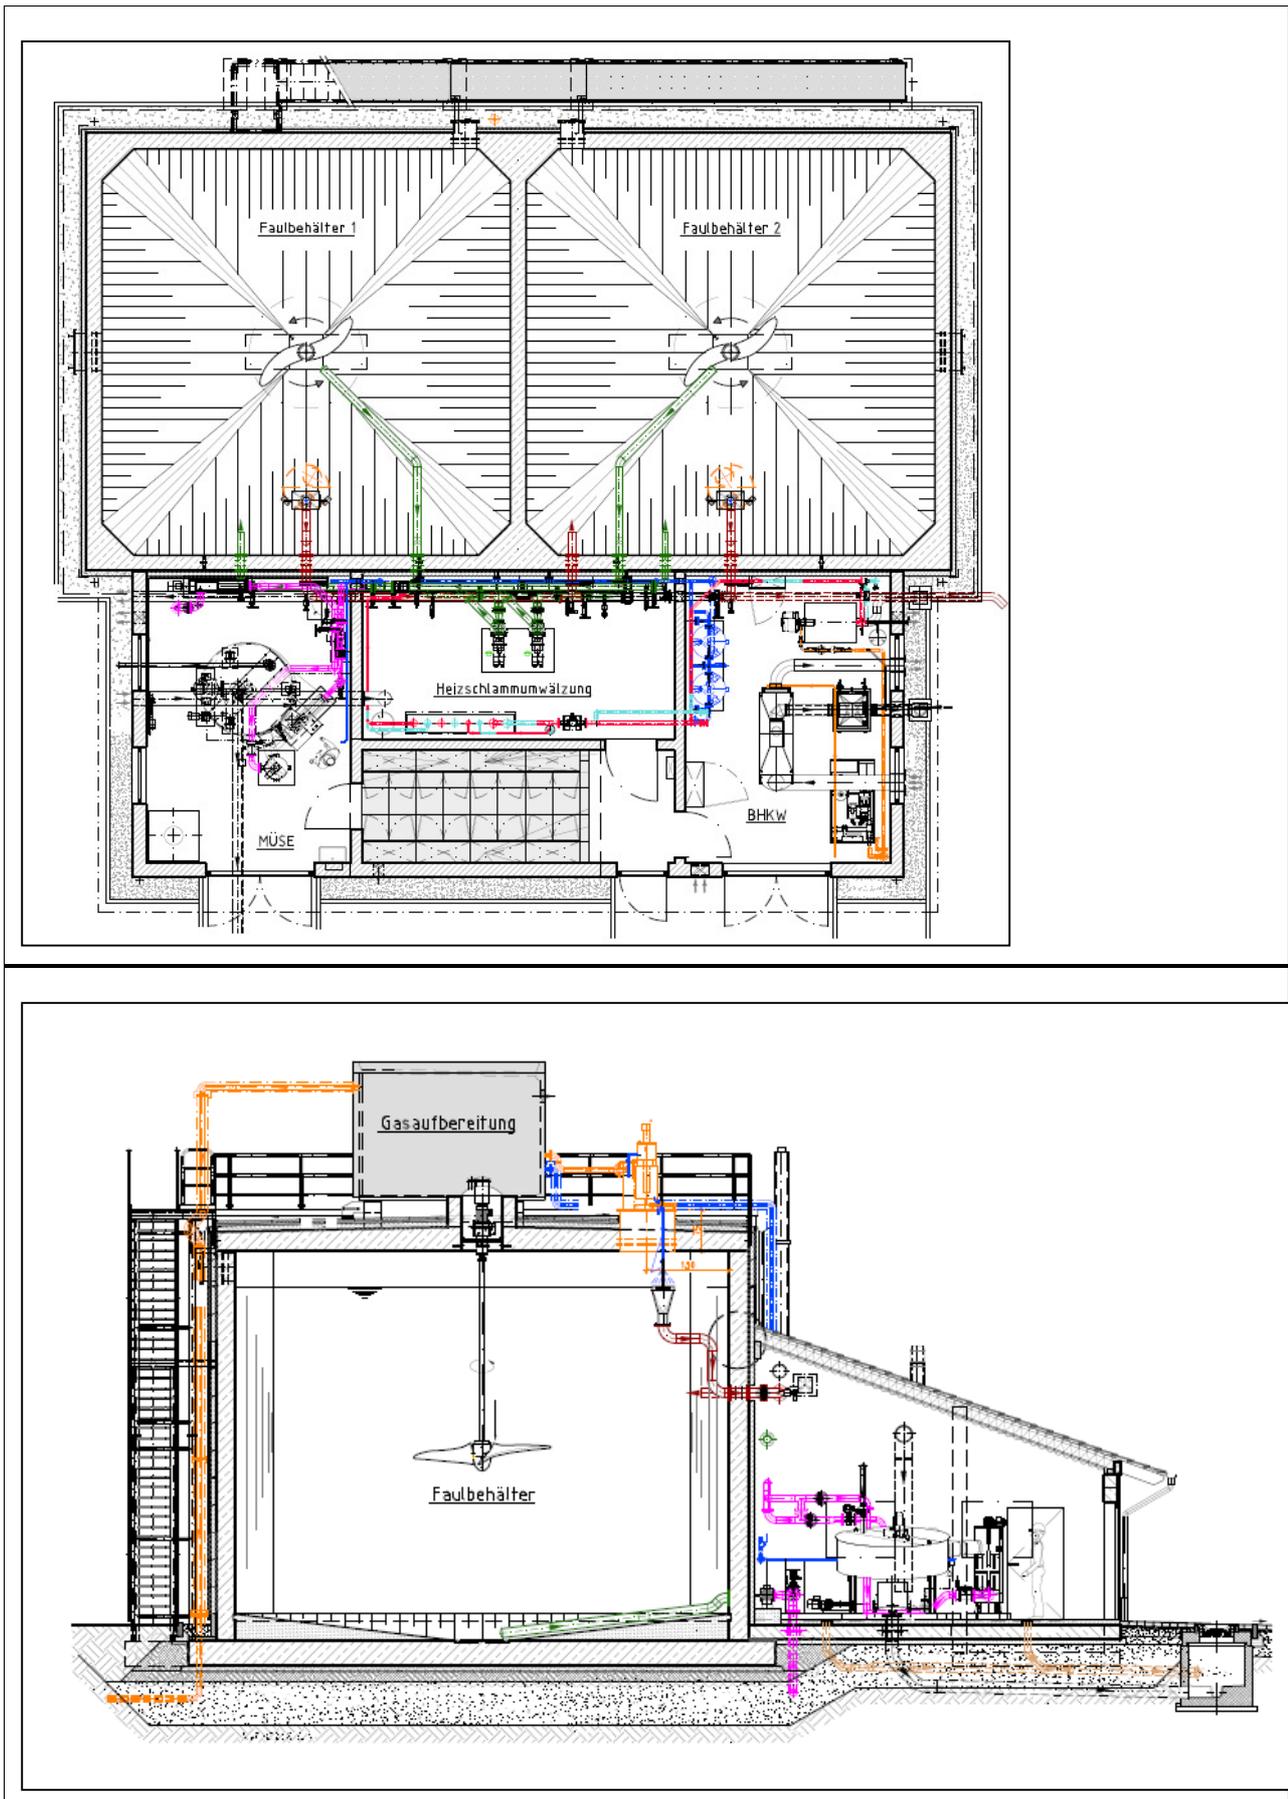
2-stufiger Kompaktfaulbehälter, Grundriss und Schnitt
